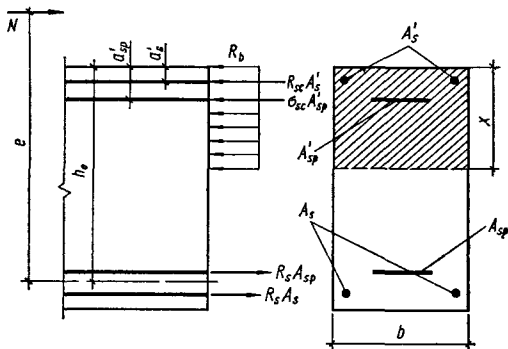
Схема усилий в прямоугольном сечении внецентренно-сжатого железобетонного элемента.
